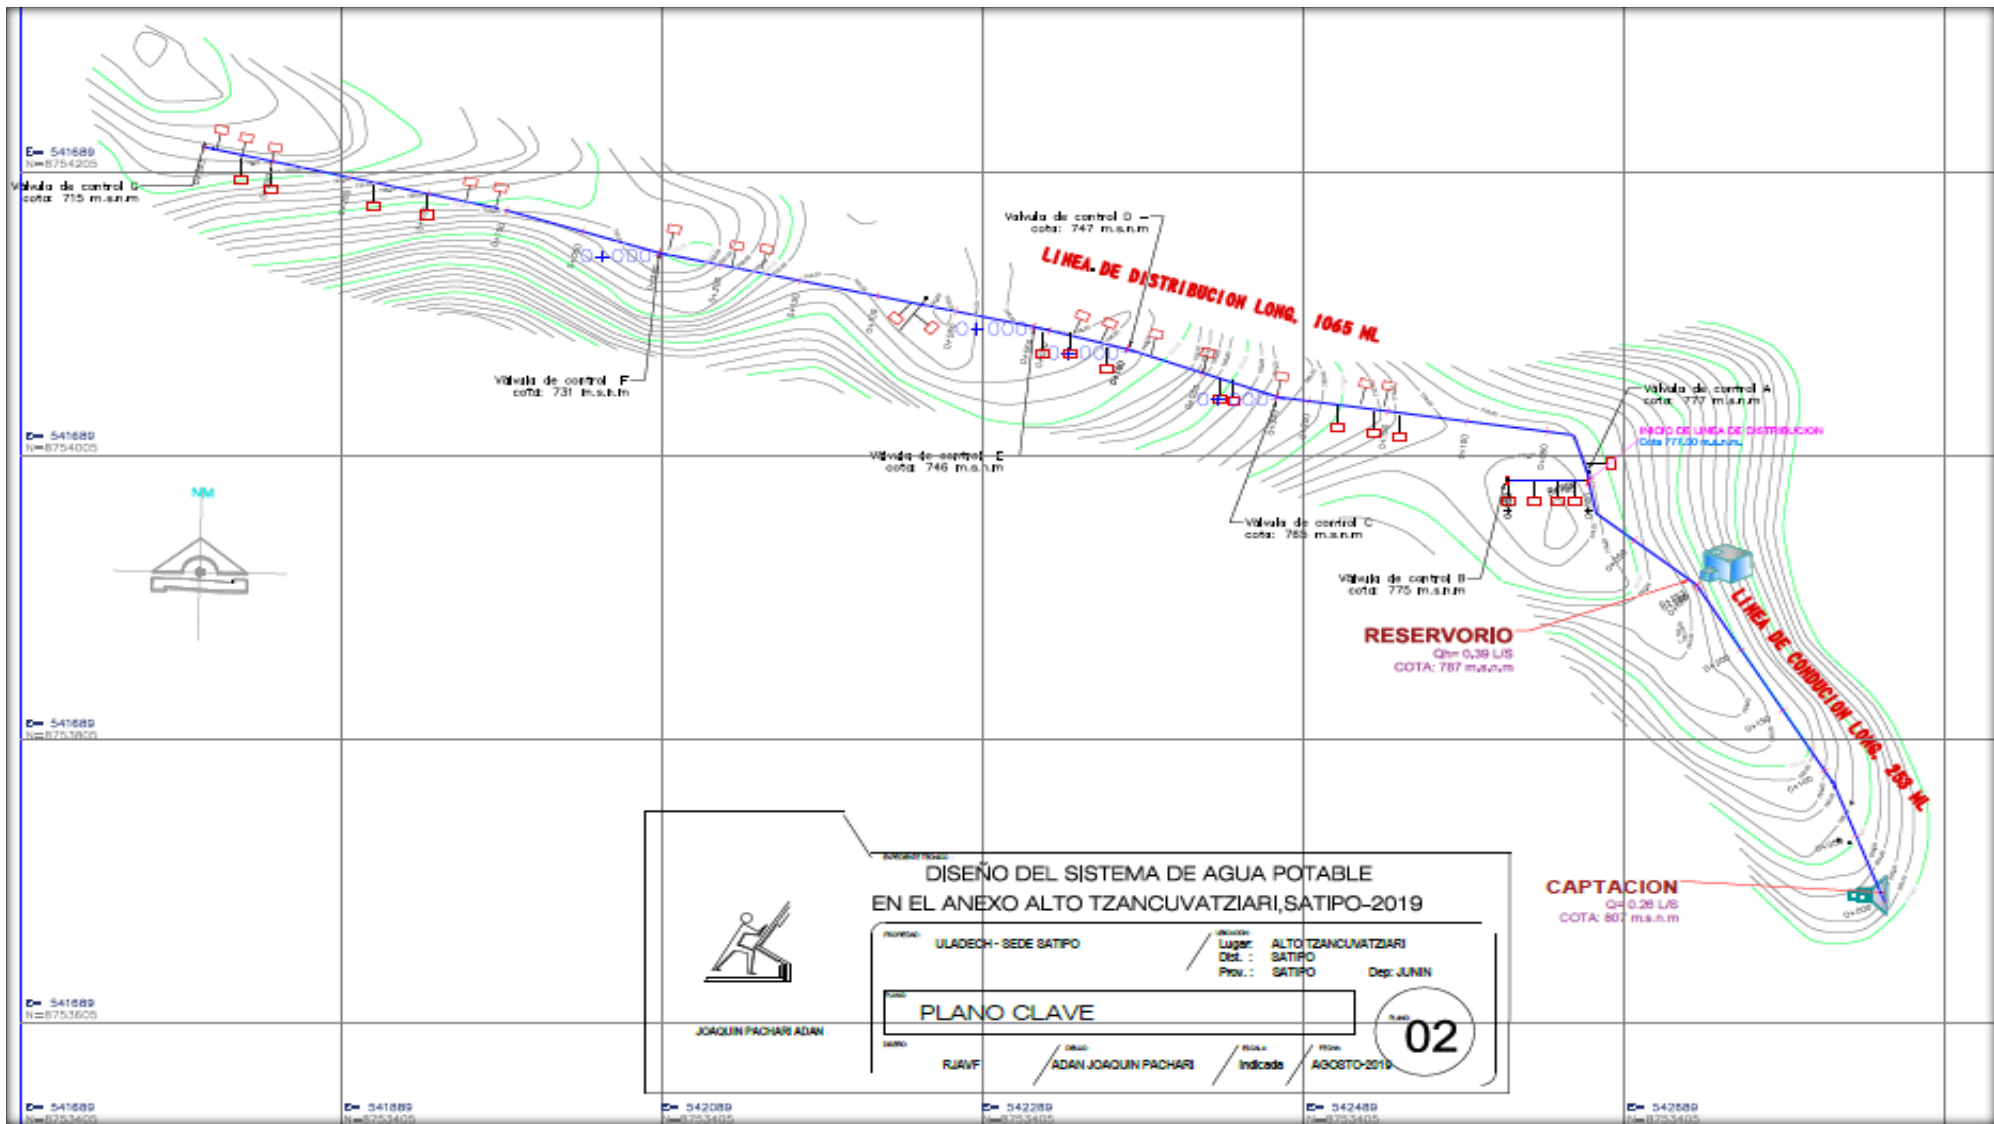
Plano topografico del sistema de Agua Potable- vista en planta
